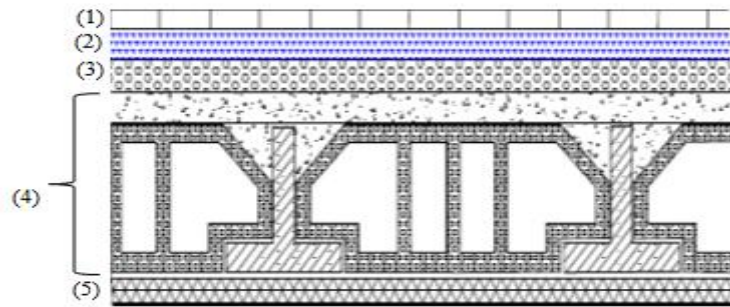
Coupe verticale du plancher courant à corps creux.
